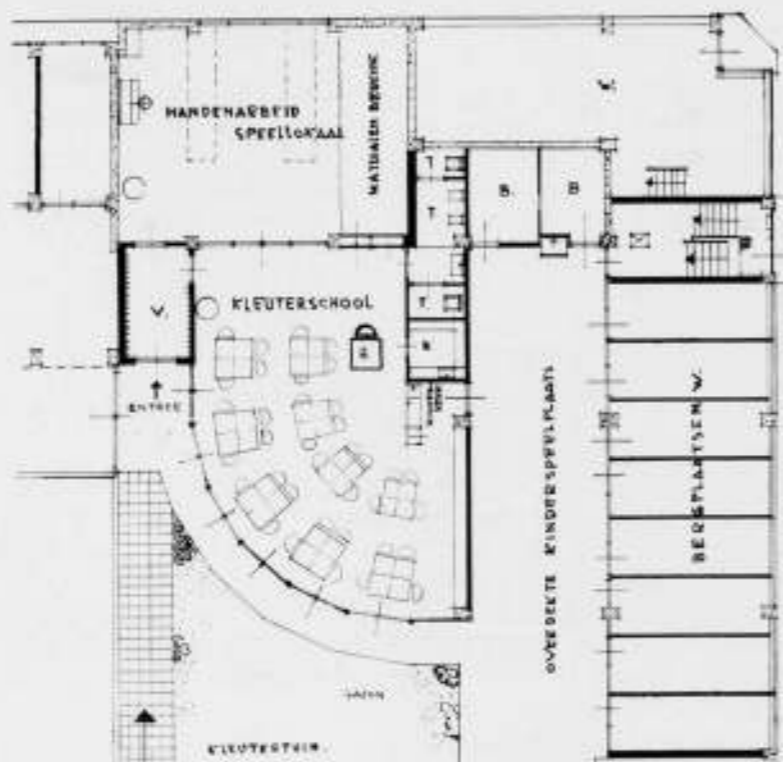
PLAN KLEUTERSCHOOL SCHAAL 1 A 200
